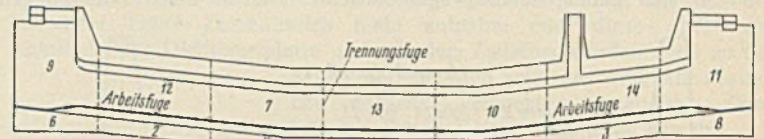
Reihenfolge der Ausführung der Baublöcke.
